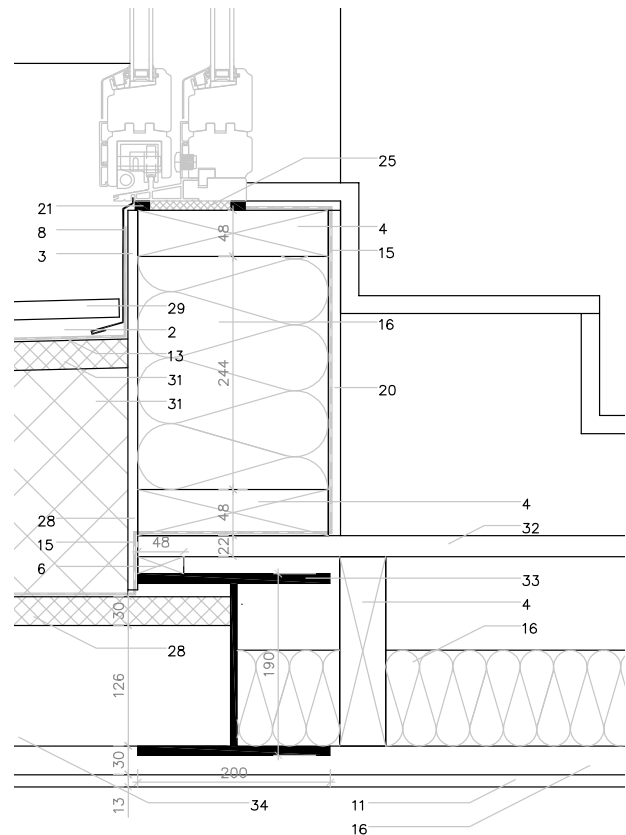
Detalle constructivo del encuentro entre el forjado interior y el de terraza
